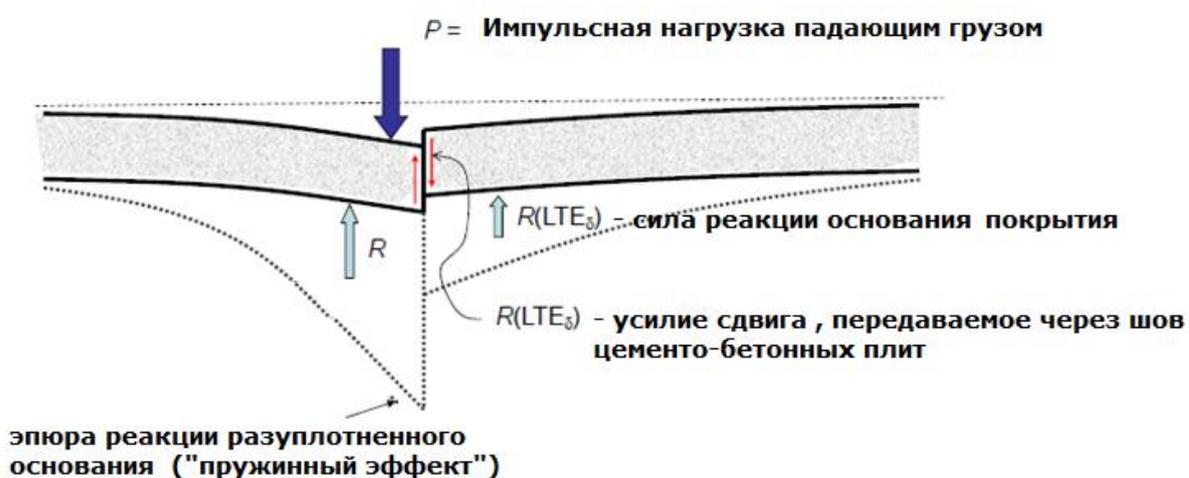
Принципиальная схема прогиба плит на швах цементобетонных покрытий
